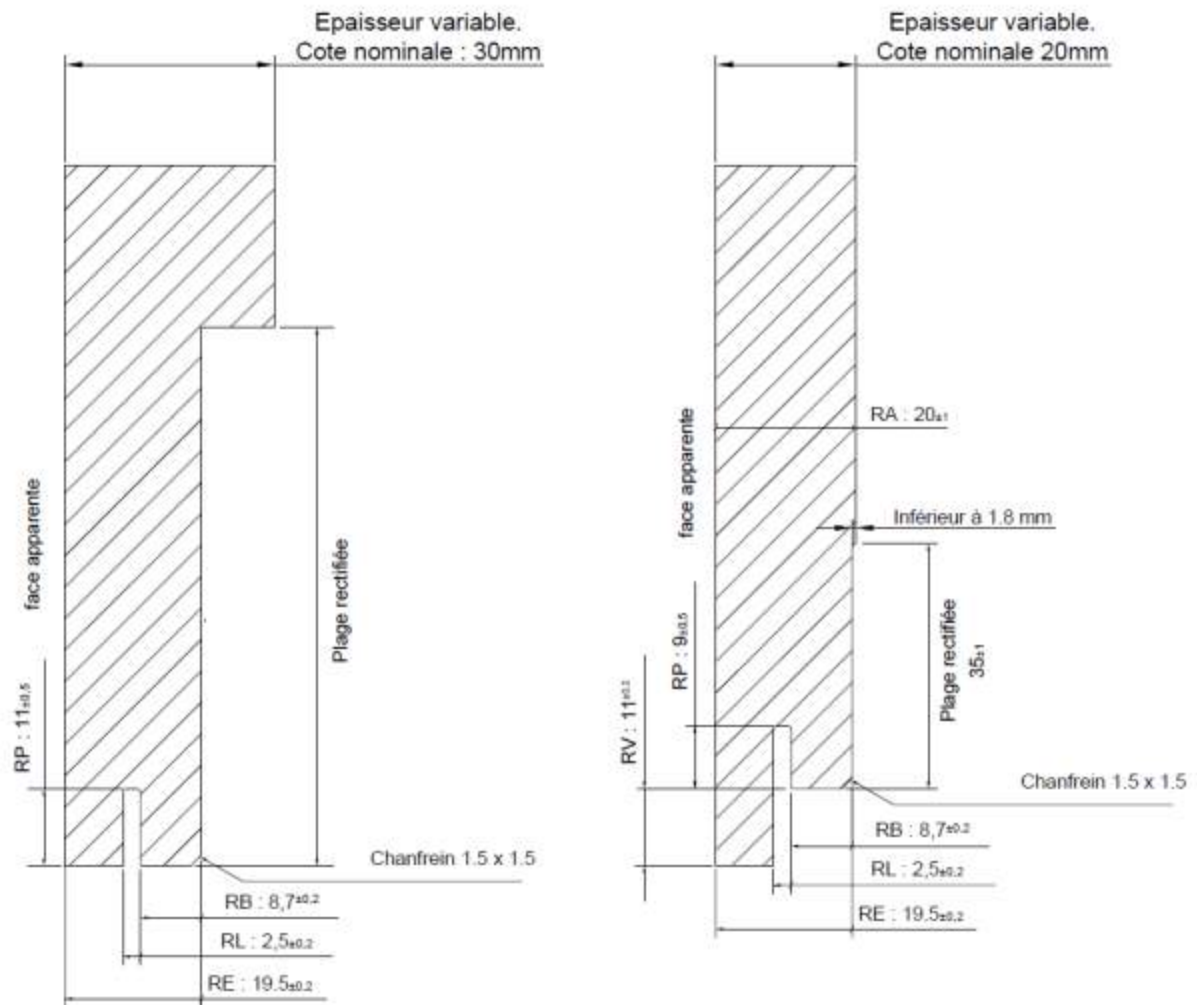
Rainure Type E continuité pierre 2 et 3 cm / Rainure type Chabillage de linteau sur rail RT
